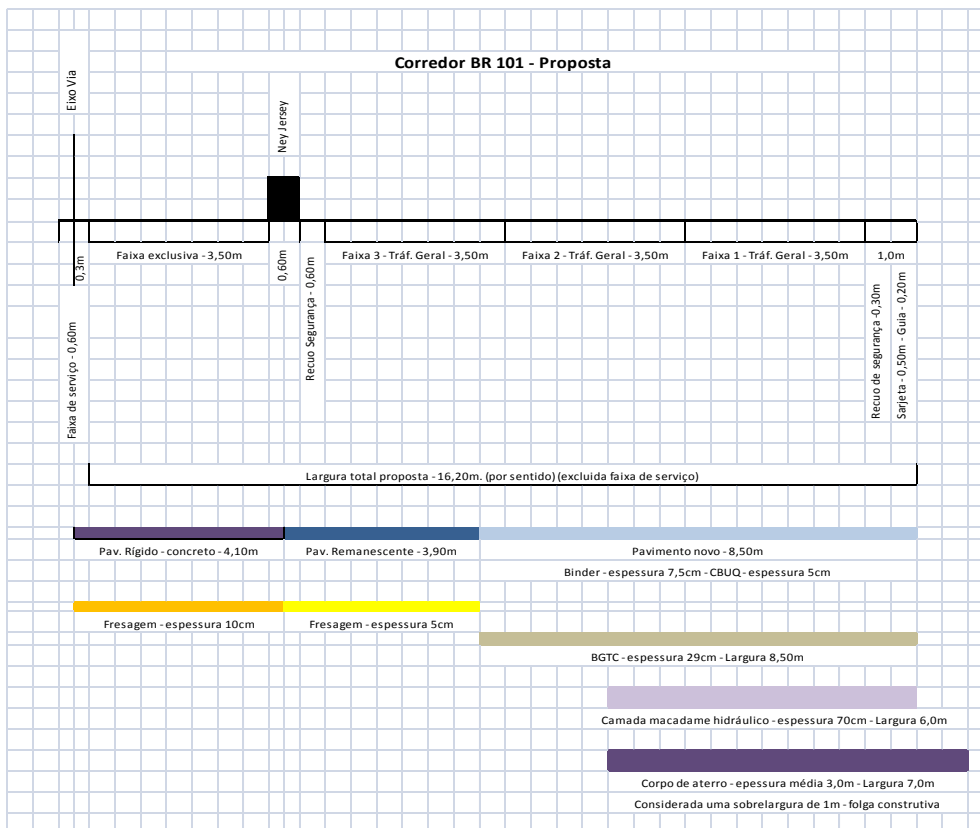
Caixa Viária – BR-101 – UFSC - Situação proposta
